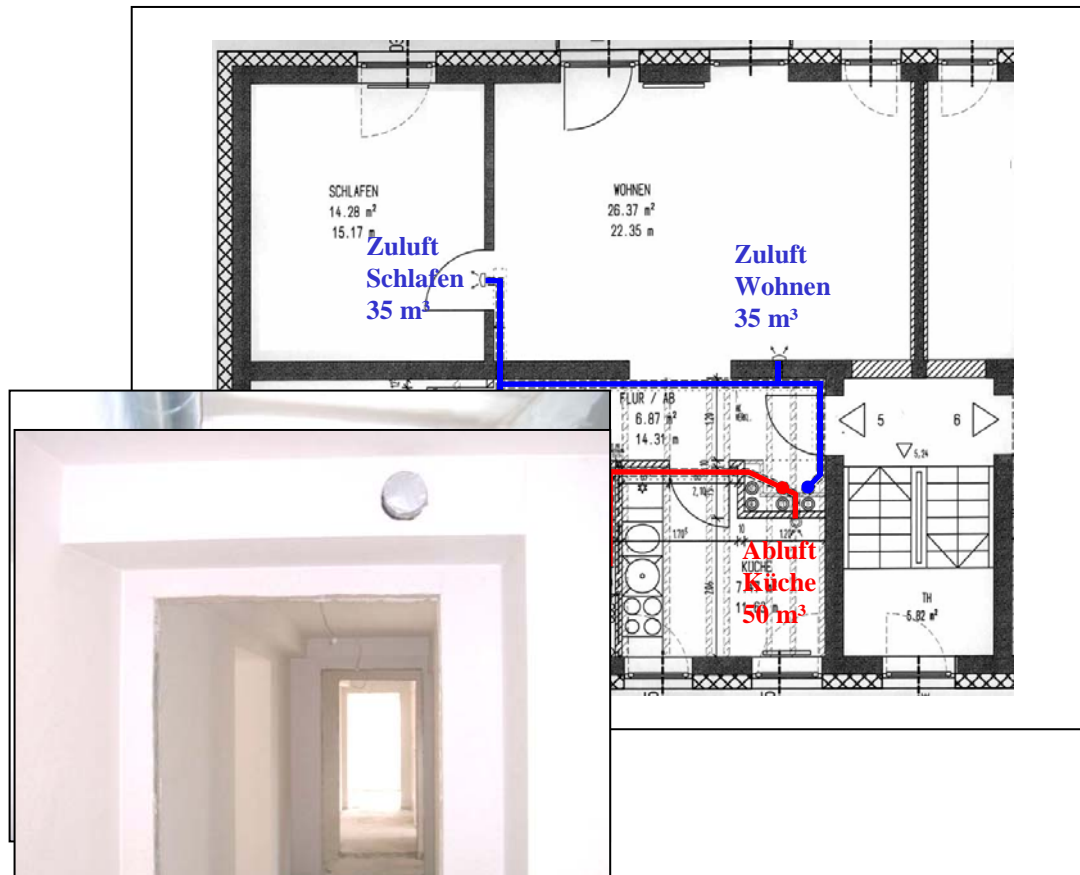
Anlagenkonzept mit Leitungsführung und Luftwechsel im Grundriss
